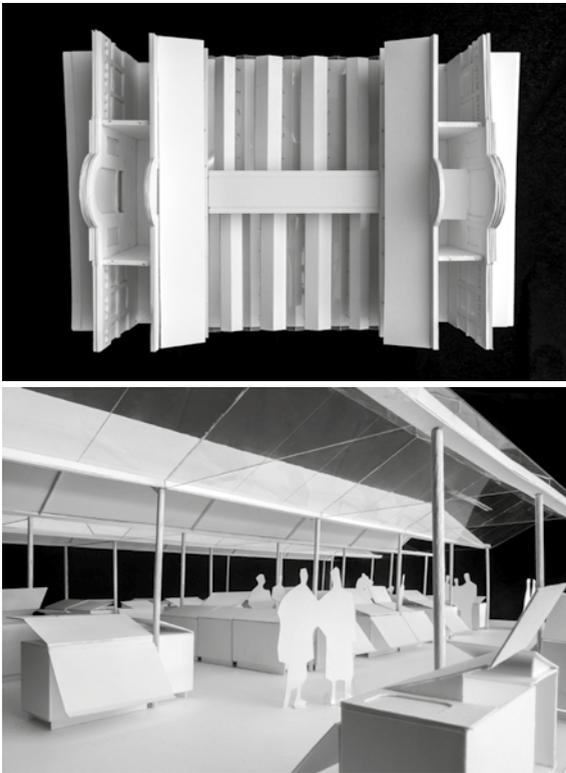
e 40. Novas estruturas do terrado - maquete de estudo.
